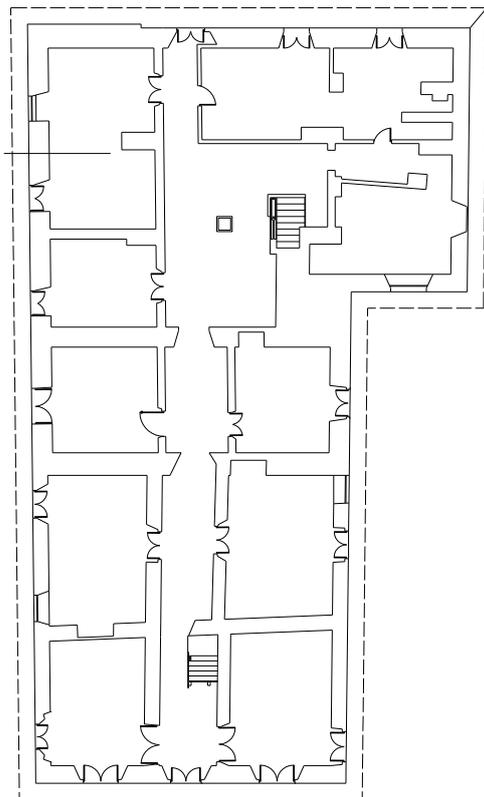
Planta Baixa Pavimento Térreo antes da intervenção no ano de 2006
